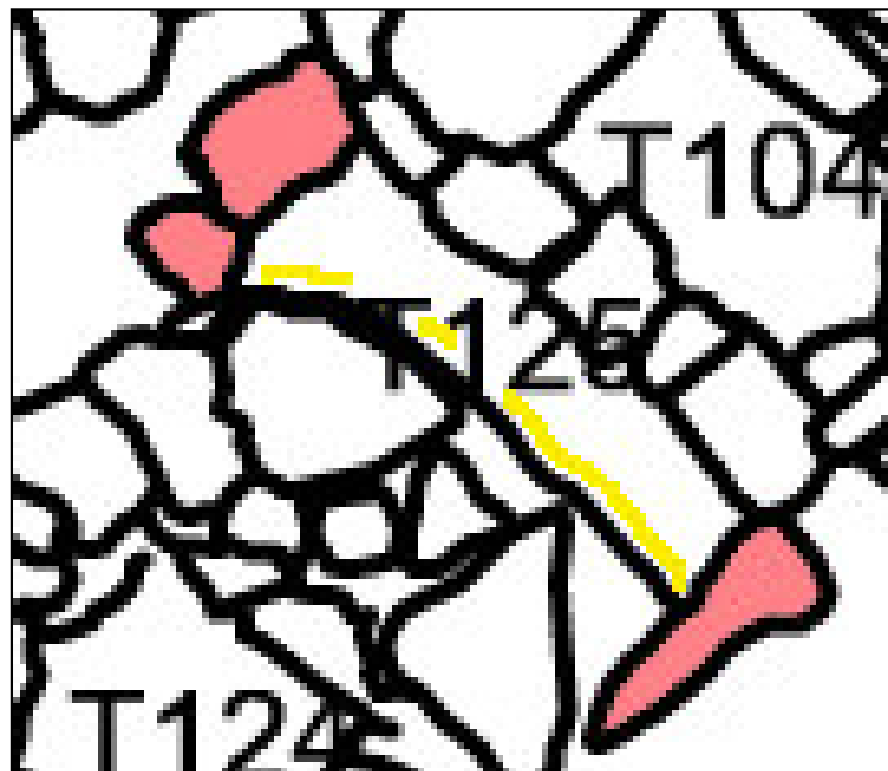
Planta de les intervencions, en vermell la zona consolidada, en groc els fonaments.
